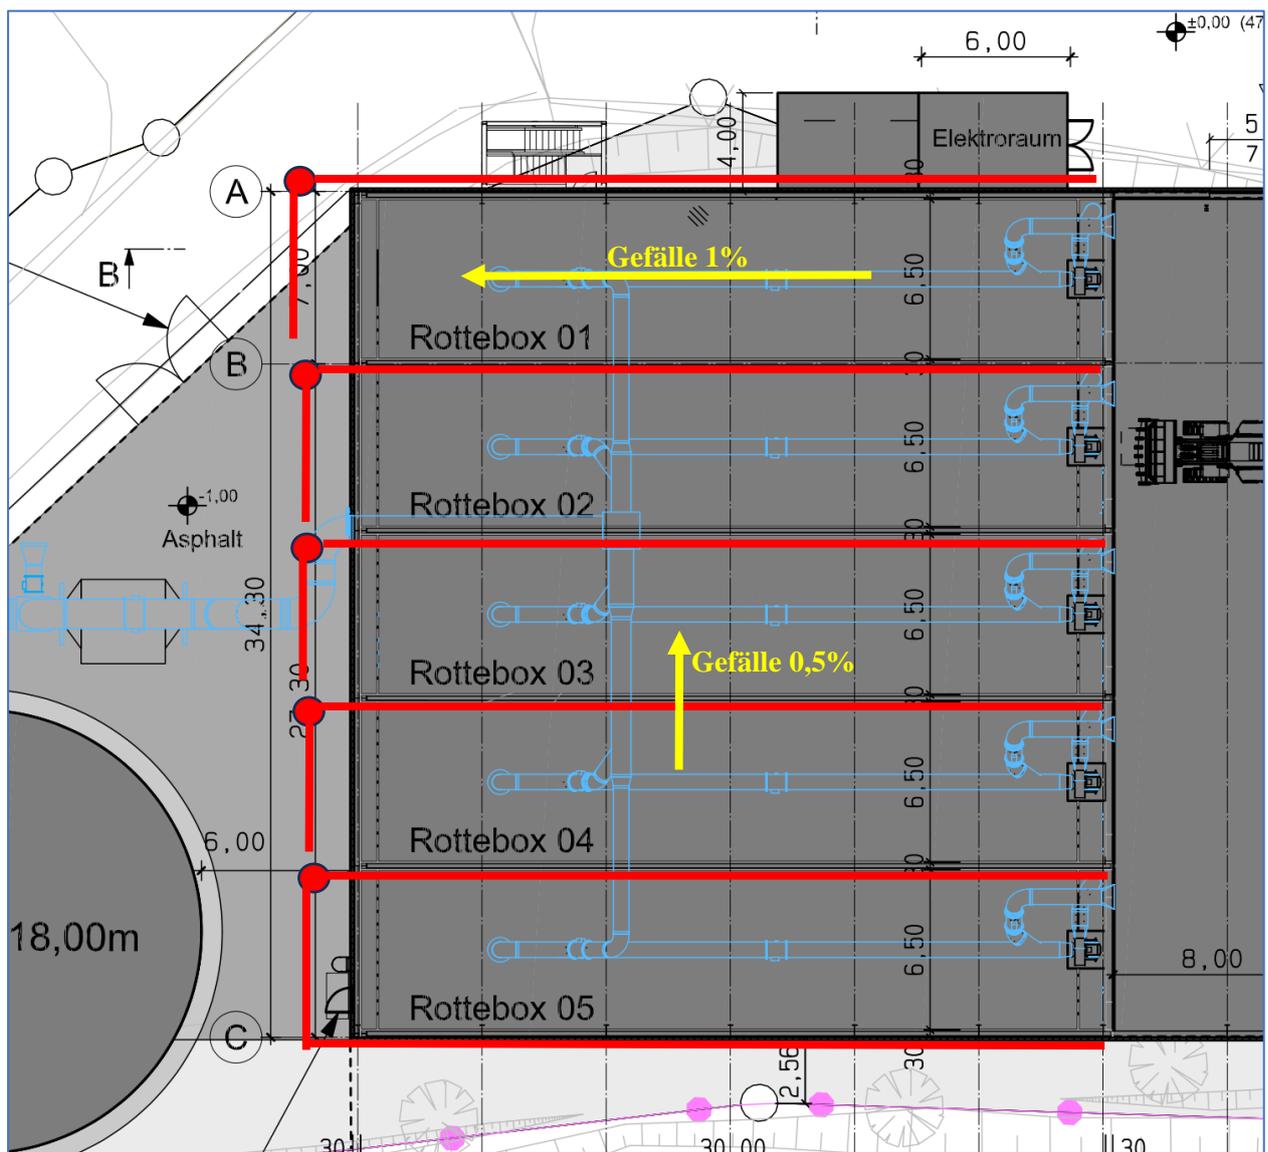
Grundriss mit eingetragenen Kontrollschächten (rot) und Dränageleitungen
